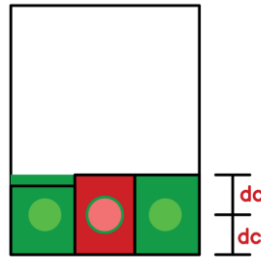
Bulbos de Hormigón en el Control de Agrietamiento. Fuente: Nicolás Pozo
